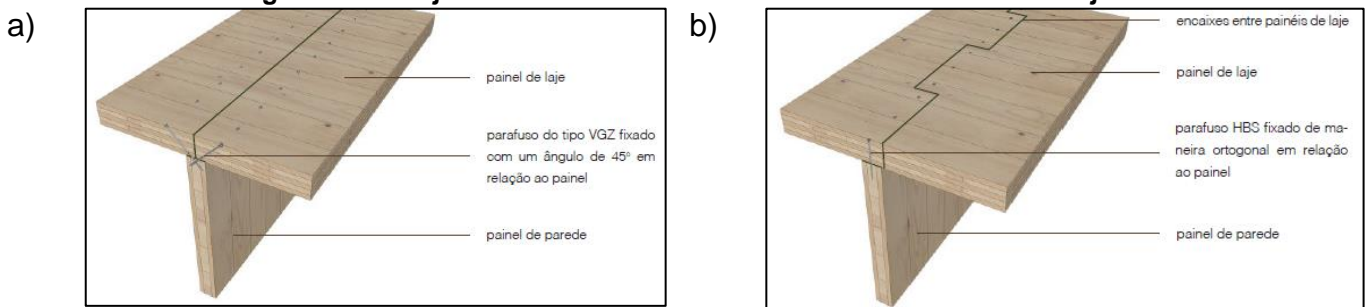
Conjunto de Detalhes Para Conexão de Paredes com Telhados
